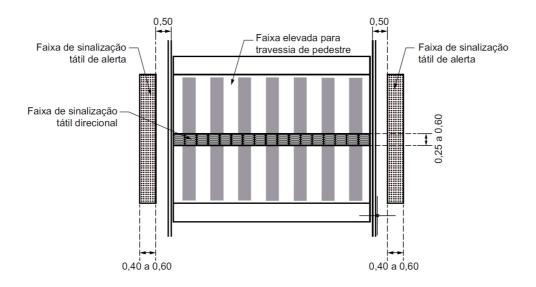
Faixa Elevada para Travessia de Pedestres. Fonte: NBR 16537/2016.
